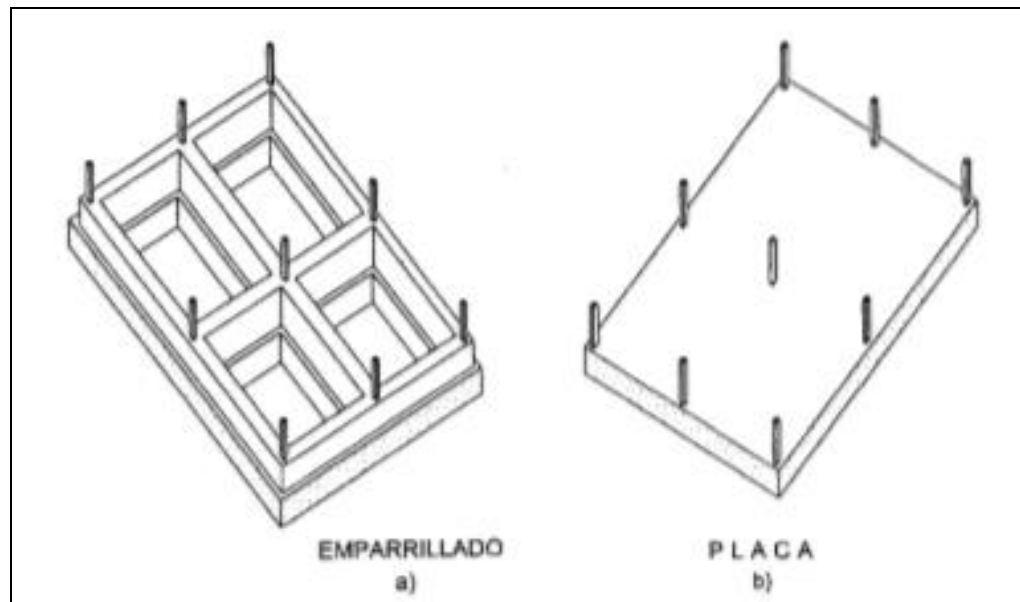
Retícula o Emparrillado y Placa o Losa rígida. Fuente: Calavera, 1982.
